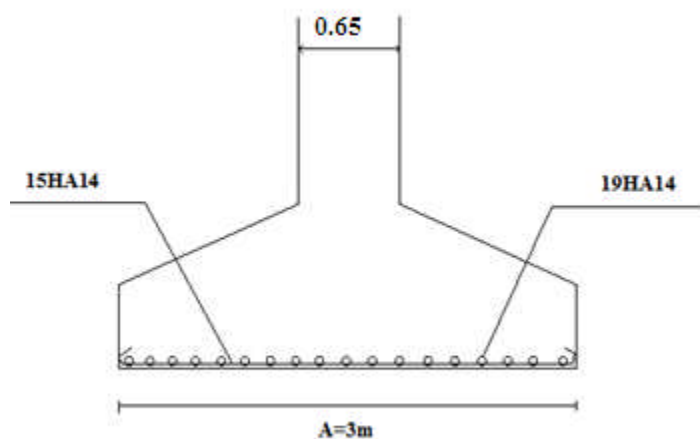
Schéma du ferrailage de la semelle (65*40).
